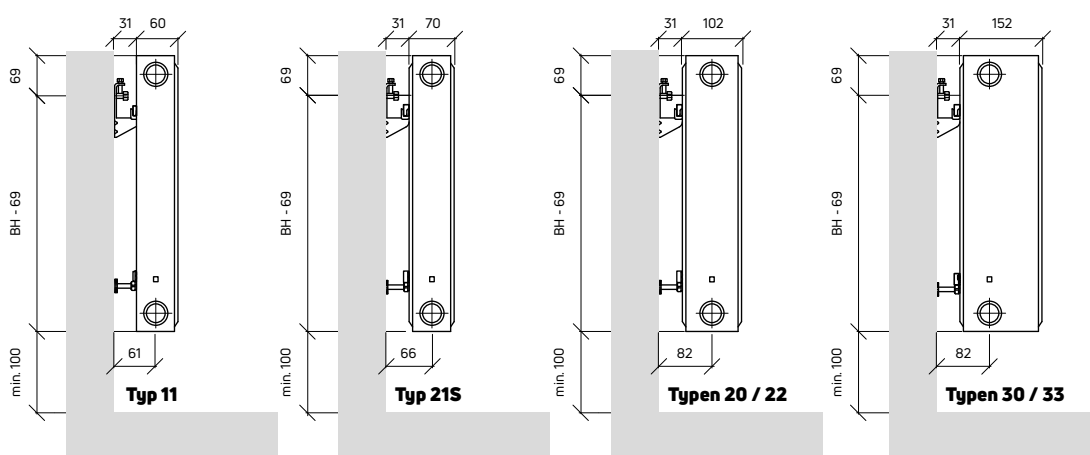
Montagemaße für Compact mit Befestigungslaschen
